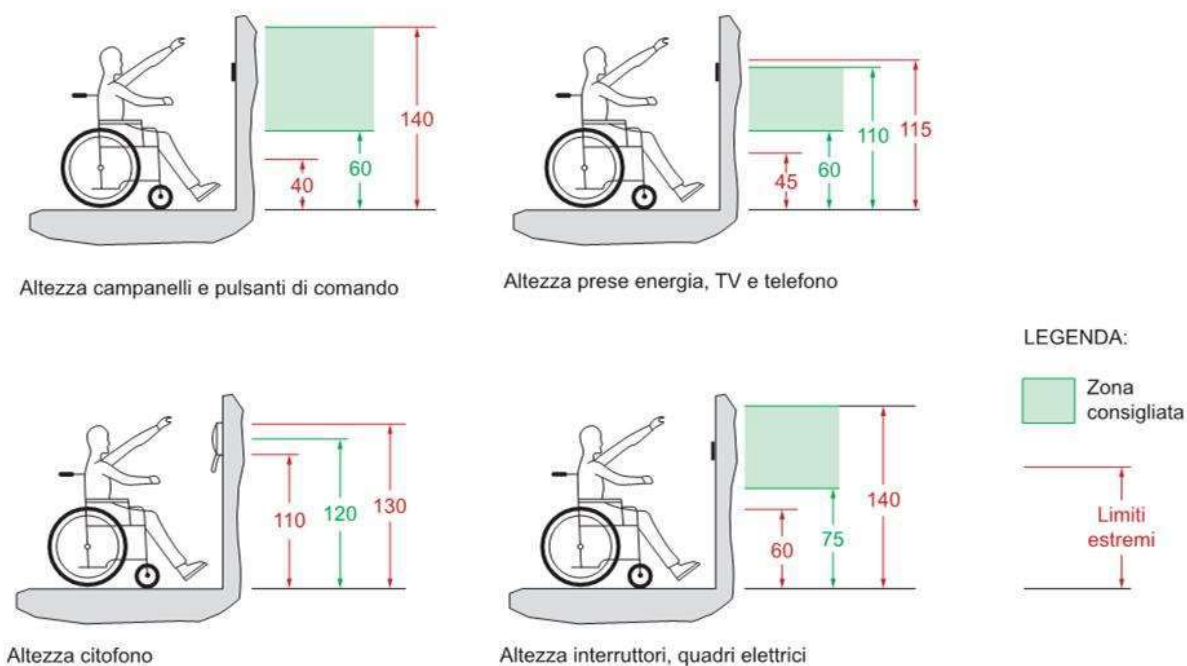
Disposizione delle apparecchiature elettriche ai fini dell'eliminazione delle barriere architettoniche (quote indicate in cm).
